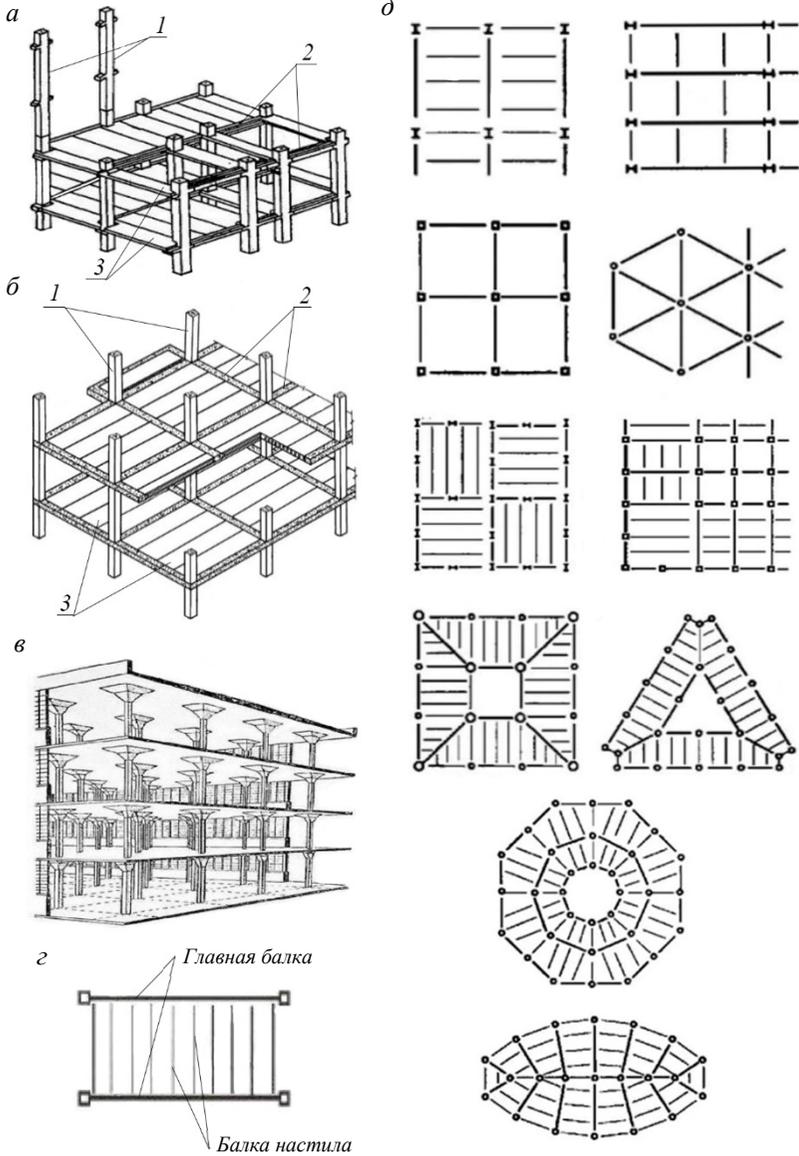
Каркасы гражданских зданий: *a* — *в* — железобетонный: сборный, сборно-монолитный, монолитный; 1 — колонна, 2 — ригель, 3 — плита перекрытия, 4 — связевой ригель, 5 — капитель колонны; *г* — компоновка балочной клетки; *д* — схемы компоновки рам
